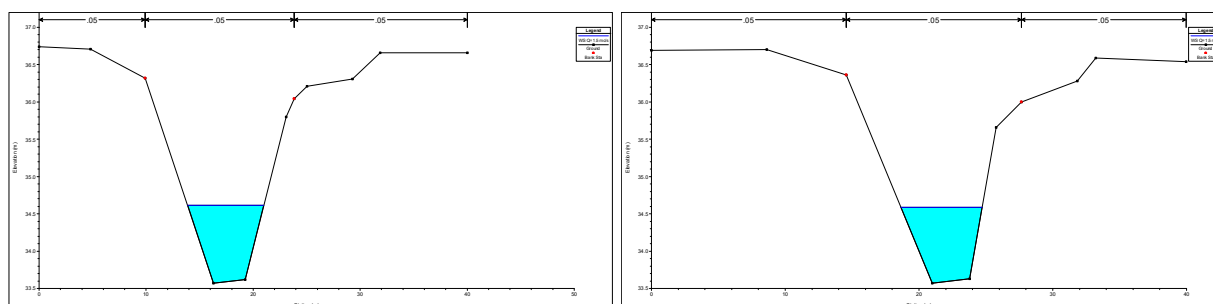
Sezione 4 (a sinistra) e sezione 3 (a destra), stato di progetto
